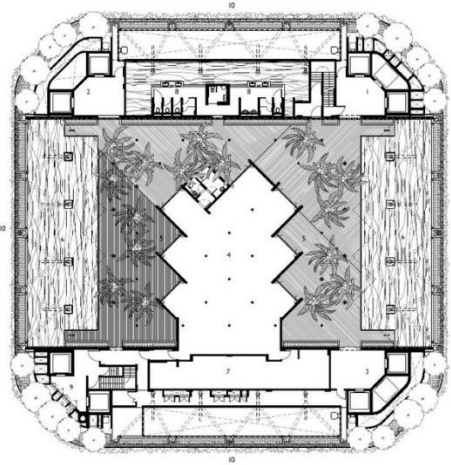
Denah Lantai 22 Oasia Hotel, Singapura
